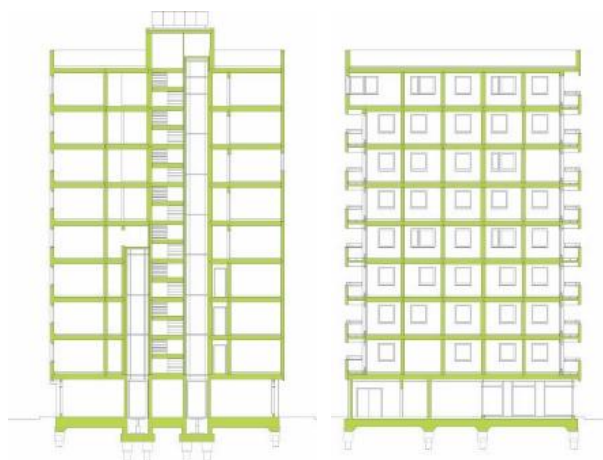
Corte Estructural Edificio Stadhaus. Plataforma de Arquitectura.
